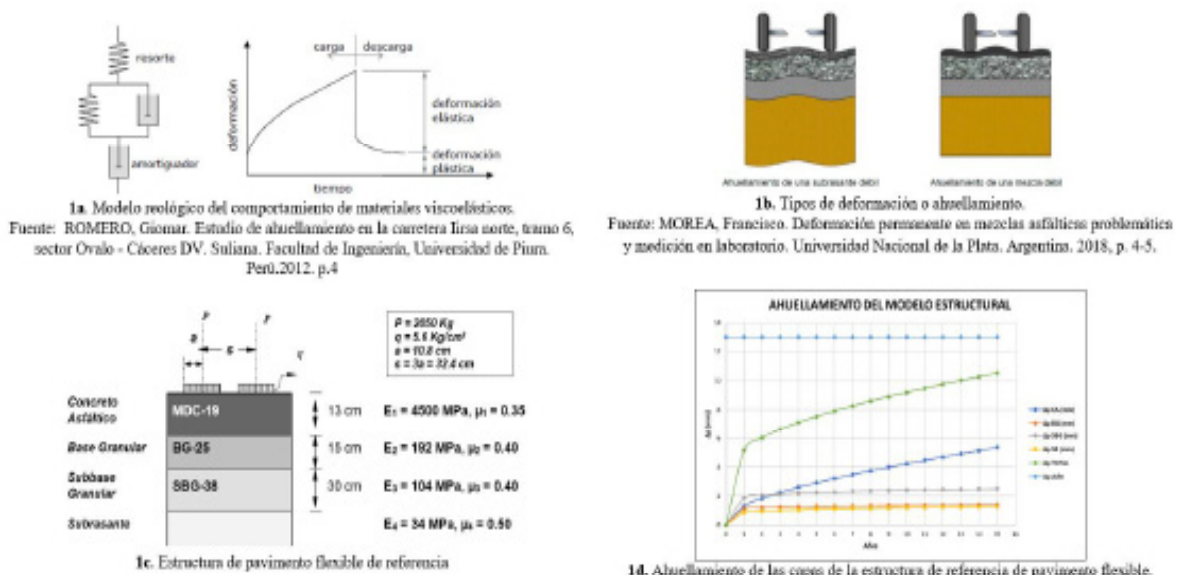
Modelo de ahuellamiento de la estructural de pavimento flexible en estudio.
